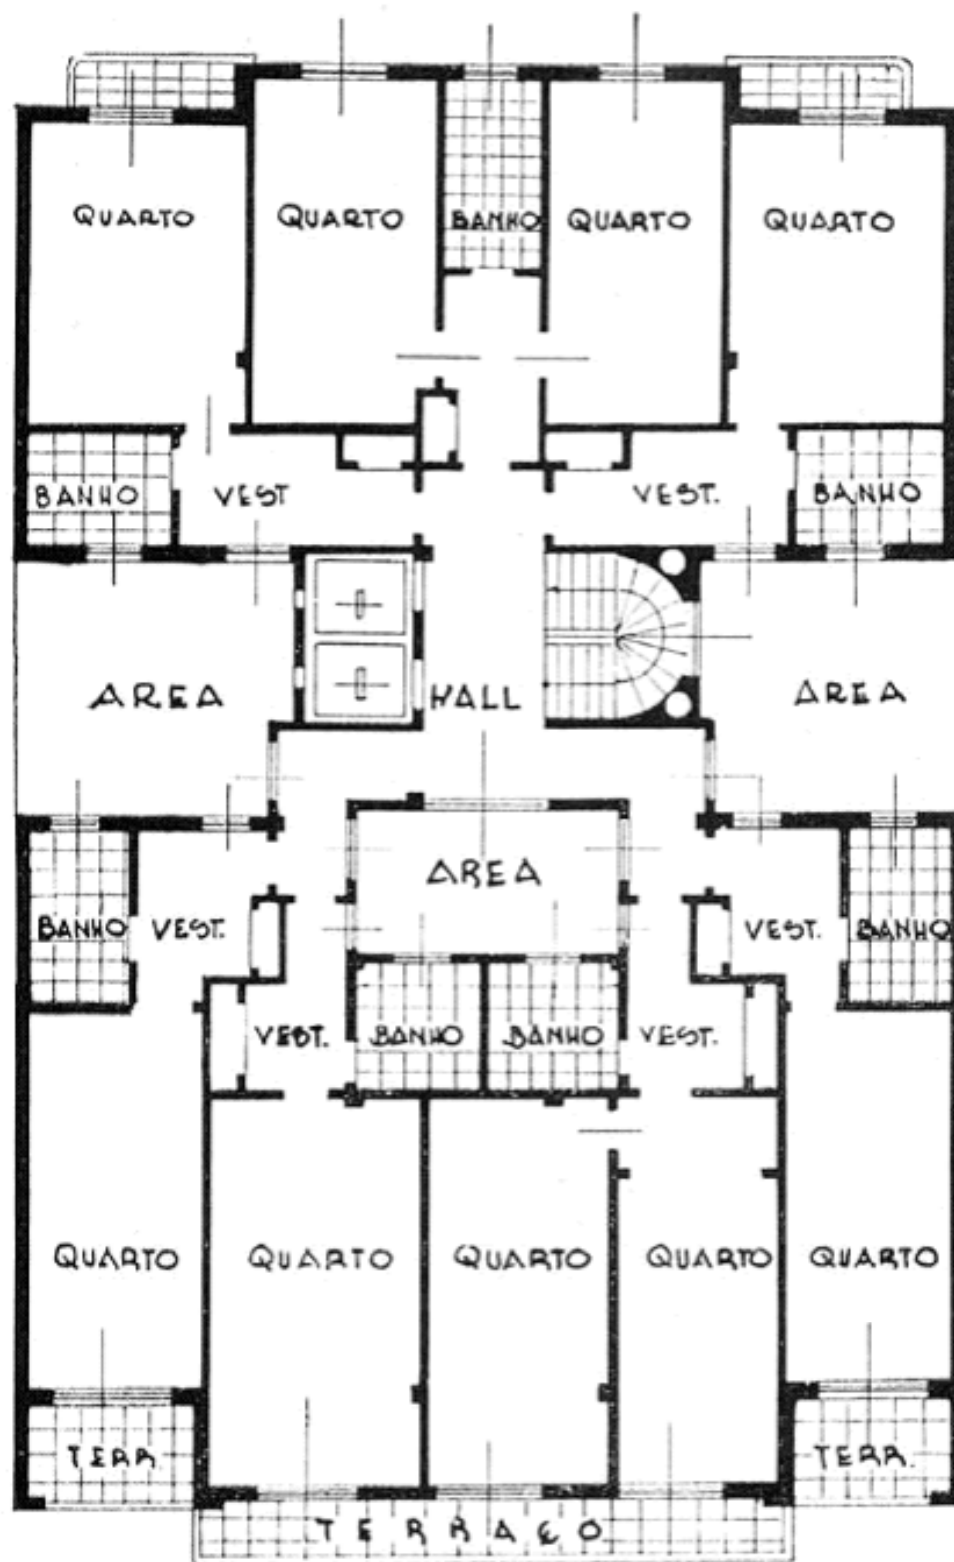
Pavimento-tipo do Edifício João Alfredo. Fonte: (PAVIMENTO..., 2008).
